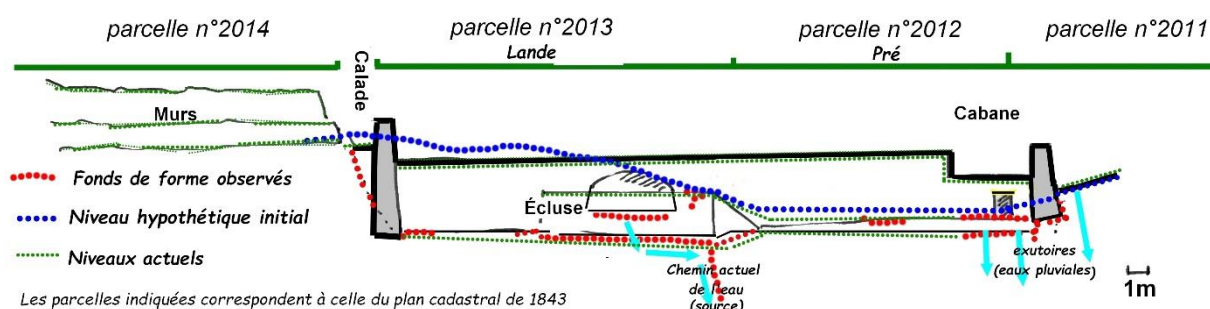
essai de reconstitution des niveaux avant les travaux du jardin.
